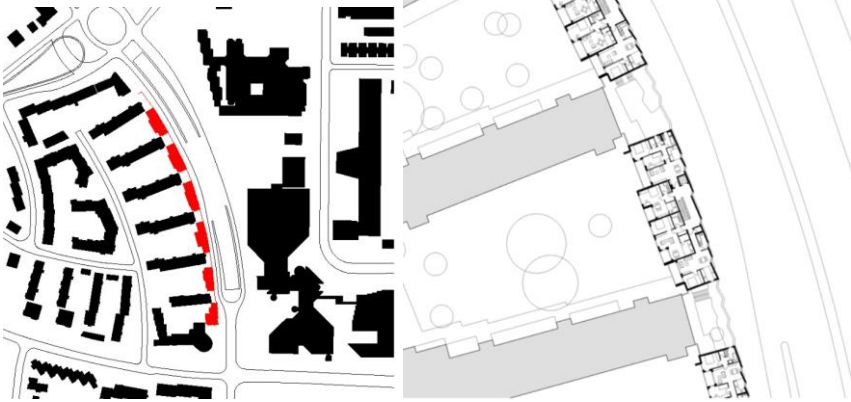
Solhagaparken Konut Kompleksi'ne ait vaziyet planı ve kat planı çizimi (Url 1, 2021).
